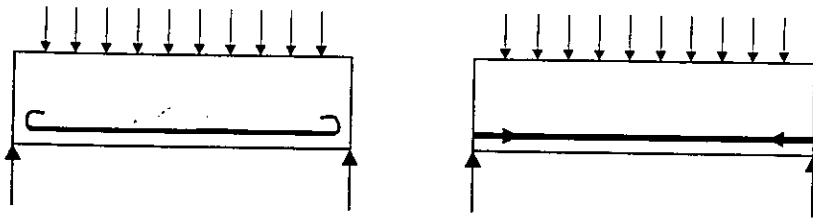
Elementos de concreto reforzado y presforzado
